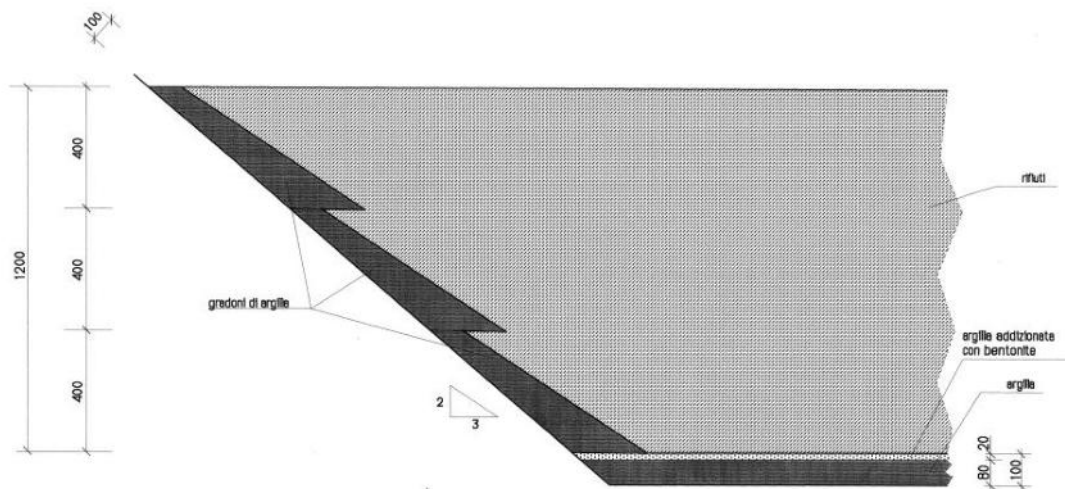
Sezione del progetto approvato, con strato di argilla sul fondo e sulle sponde
